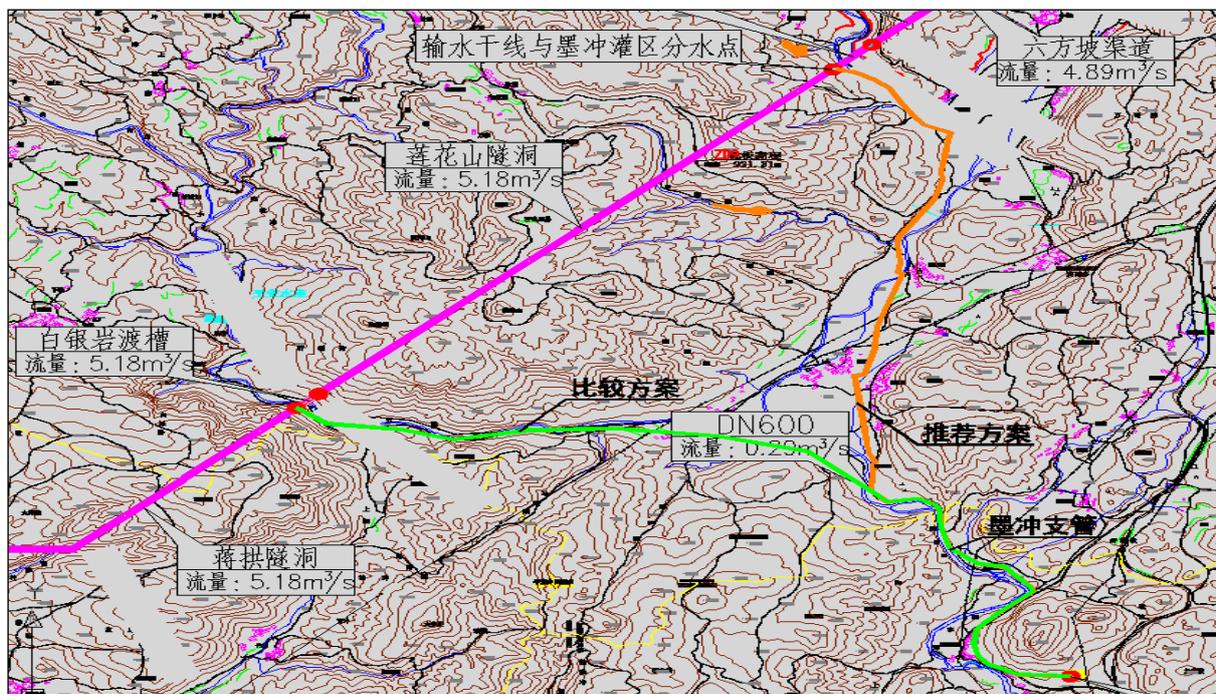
墨冲小城镇供水线路比选平面布置图
